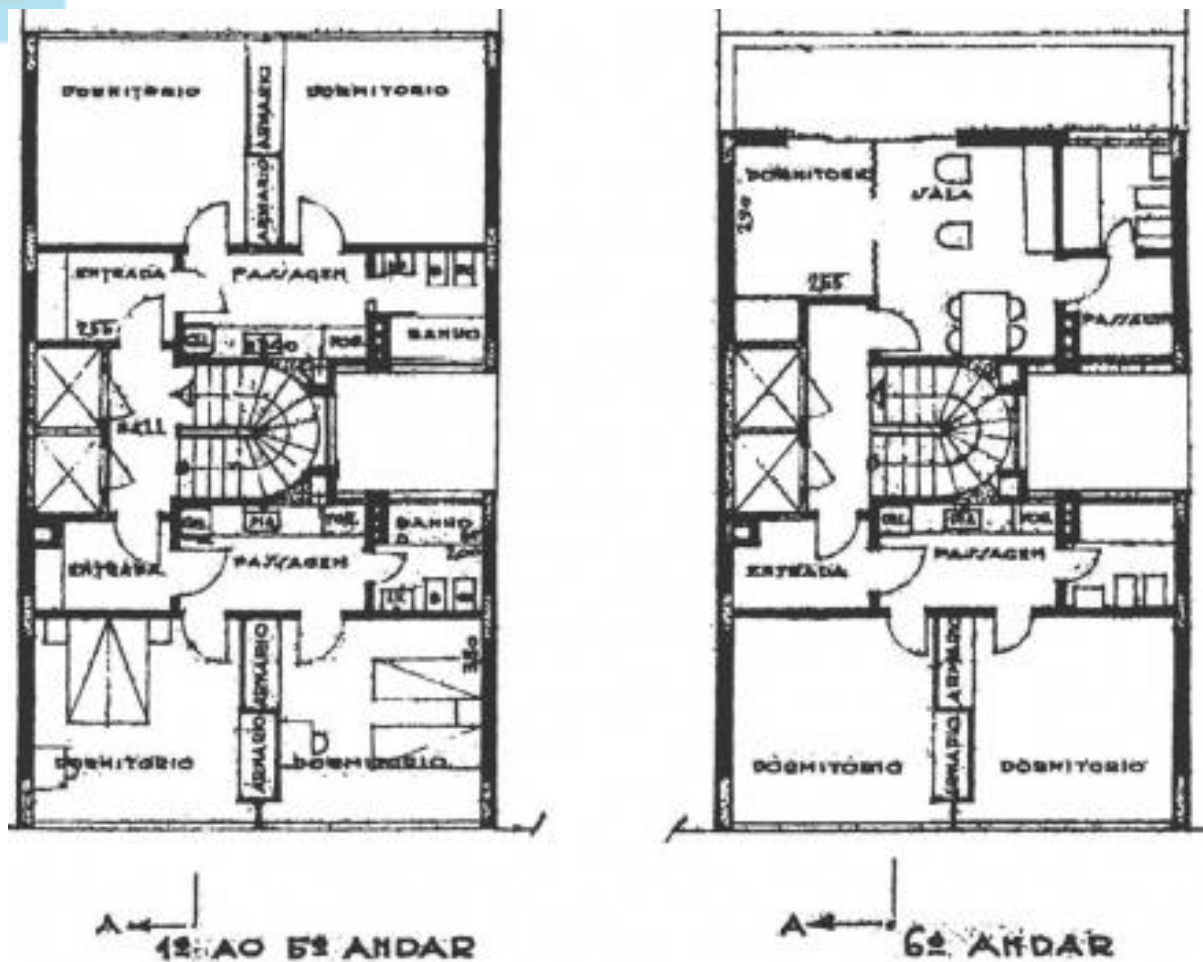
Planta Baixa Edifício à Rua Abranches, 1939.
